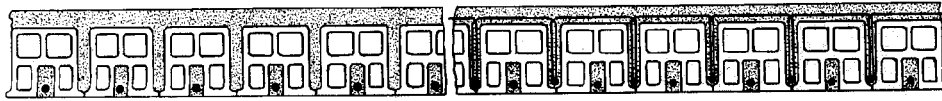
ª Suelo terminado sin armadura. FIGURA 4ª Suelo terminado con armaduras suplementarias.
